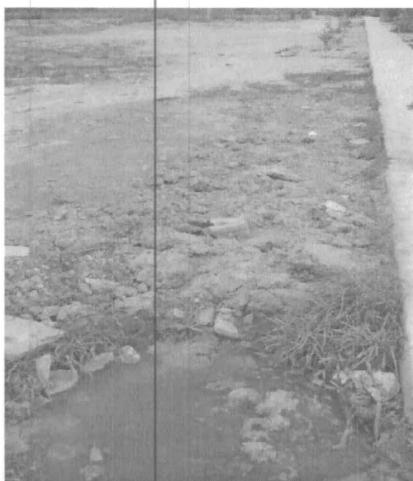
y 2. Se observa el rebosamiento del manhole ubicado en el barrio Villa Nerys
